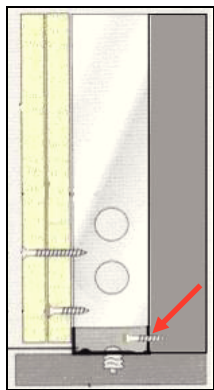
esempio di posa errata del telaio metallico, fissato anche alla parete divisoria
